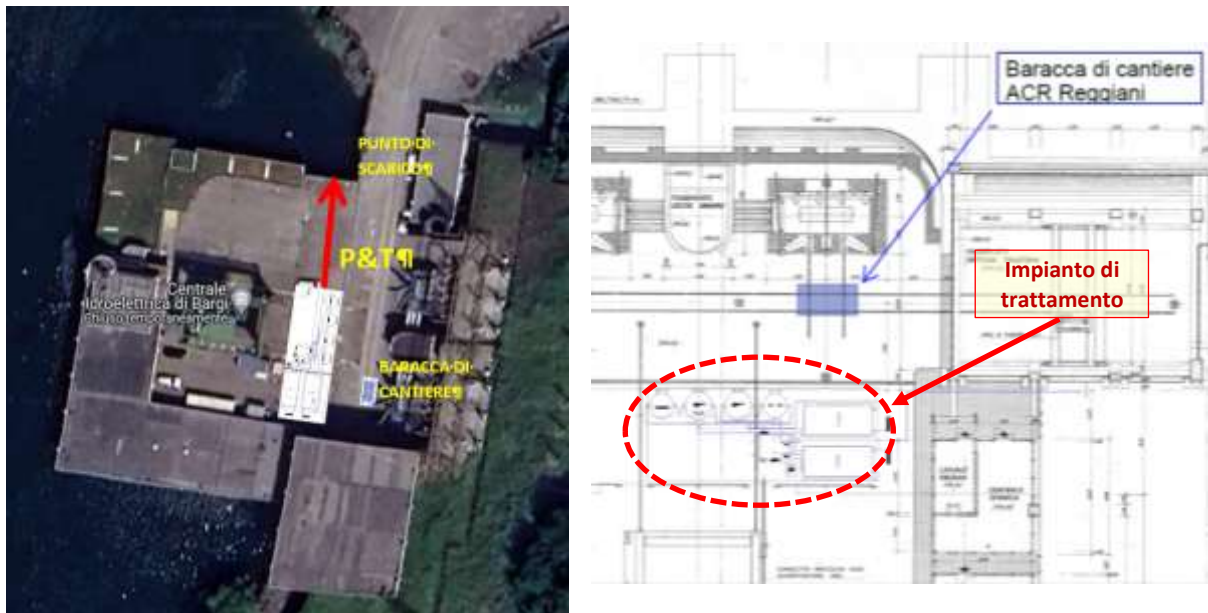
C.le di Bargi - Localizzazione e posizionamento impianto
